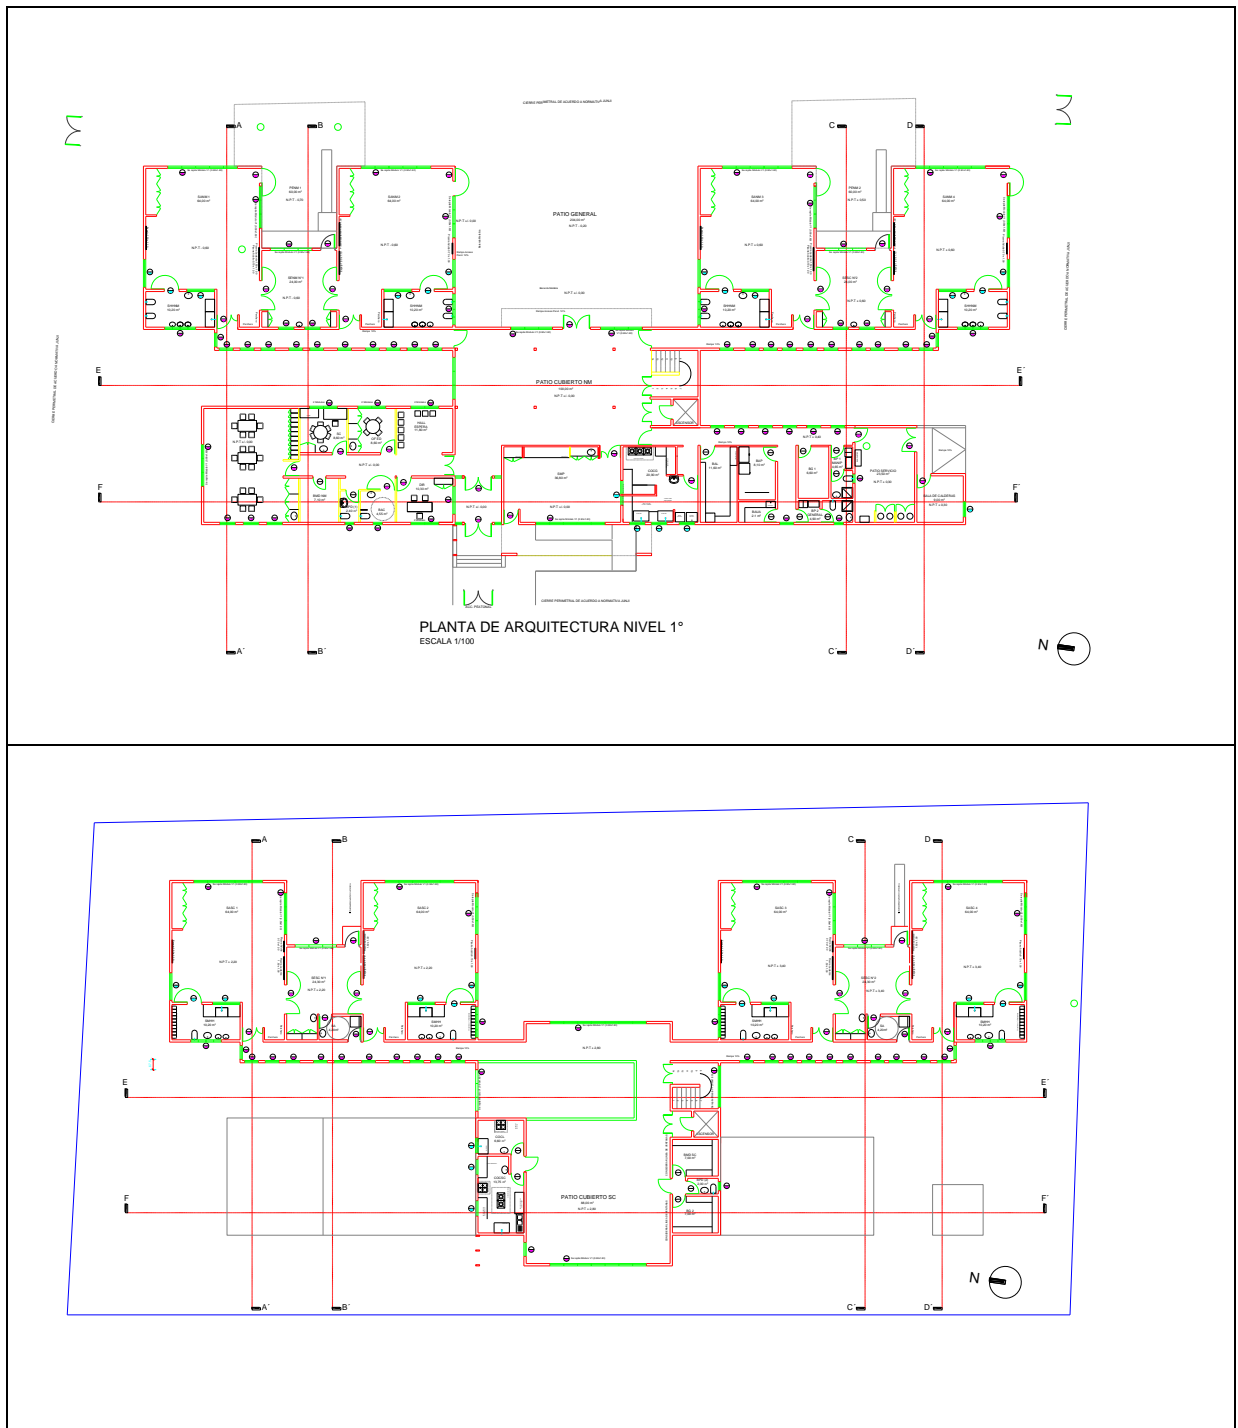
Plantas del Edificio JUNJI, primer piso (arriba) y segundo piso (abajo)
